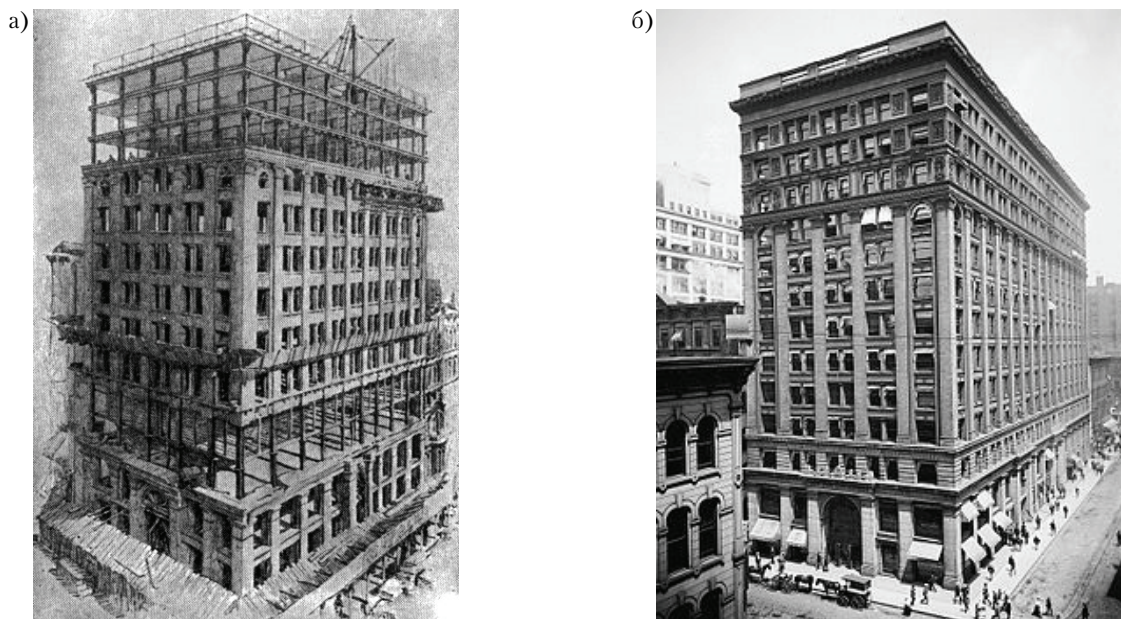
Монаднок – билдинг. (The Monadnock Building), Чикаго, 1891 г., США. Архитектор Уильям Ле Барон Дженни: а) фасад и план здания; б) фрагмент фасада здания.
